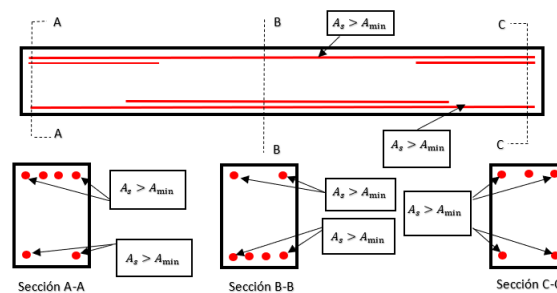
Refuerzo típico a lo largo de la longitud de un elemento estructural tipo viga.
